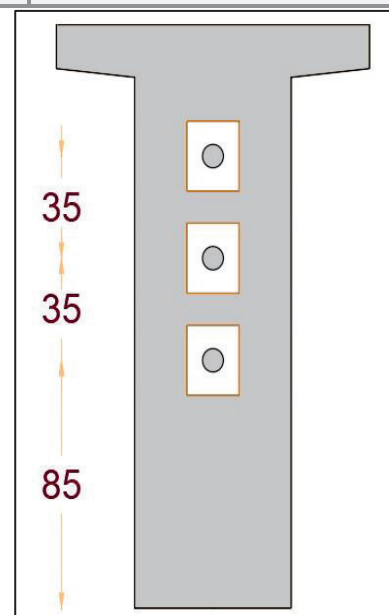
POSITION DES CABLES-SECTION D'ABOUT.
